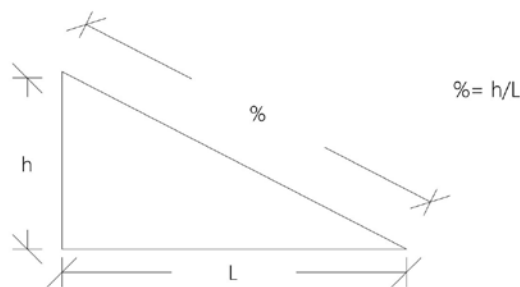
Cálculo de pendiente de rampas
